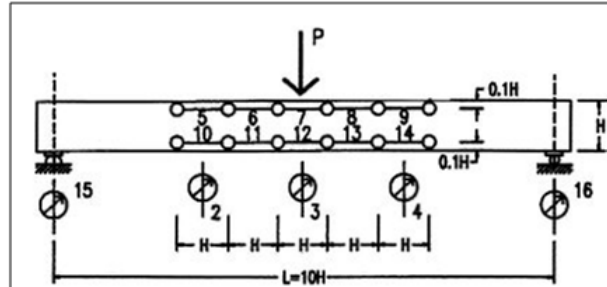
Schéma des conditions d'essai et de chargement des poutres de l'expérimentation
